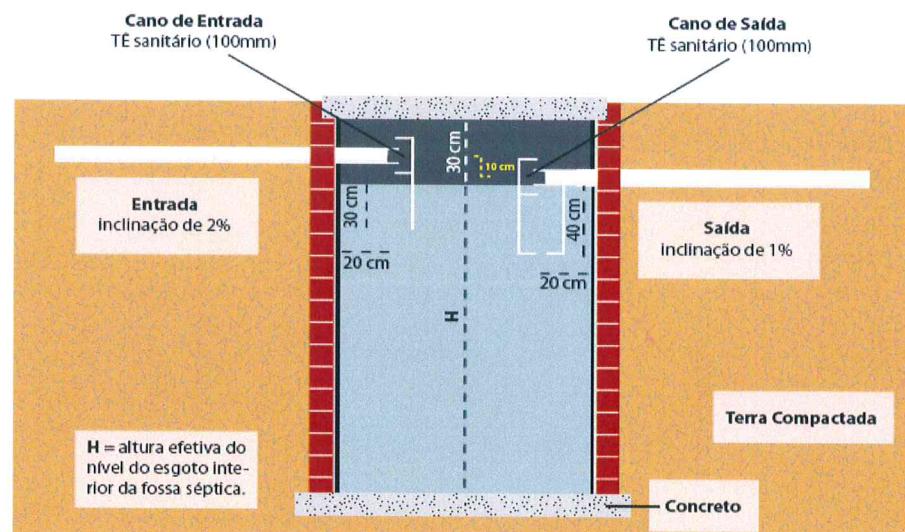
Dimensionamento de Tanque séptico conforme NBR 7229.
